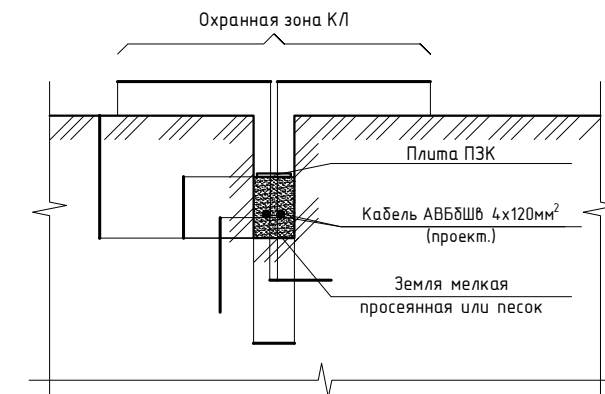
Поперечный разрез кабельной траншеи с 1 КЛ
